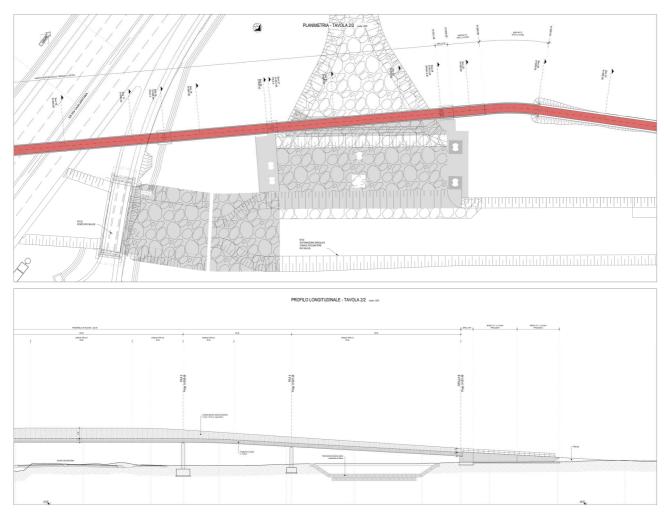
Pianta e prospetto del ponte (2 di 2)
